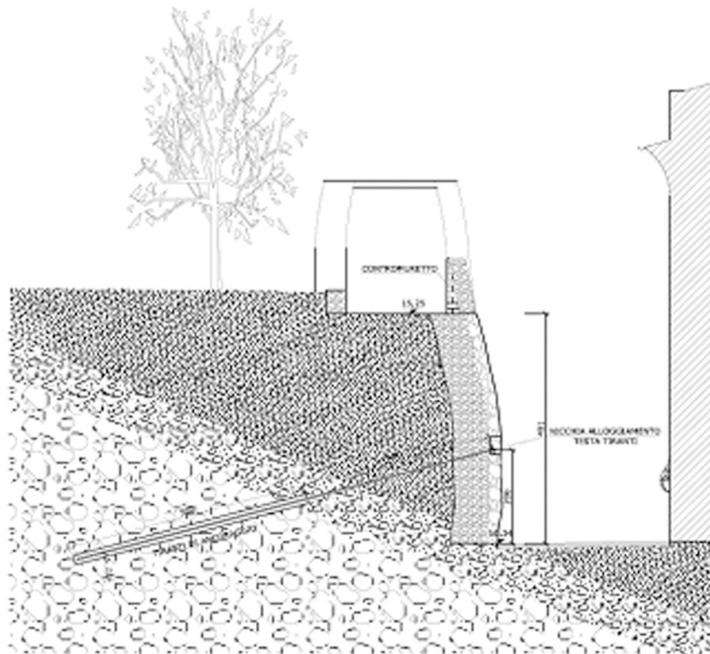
Sezione tipo: la stabilità viene assicurata da tiranti
